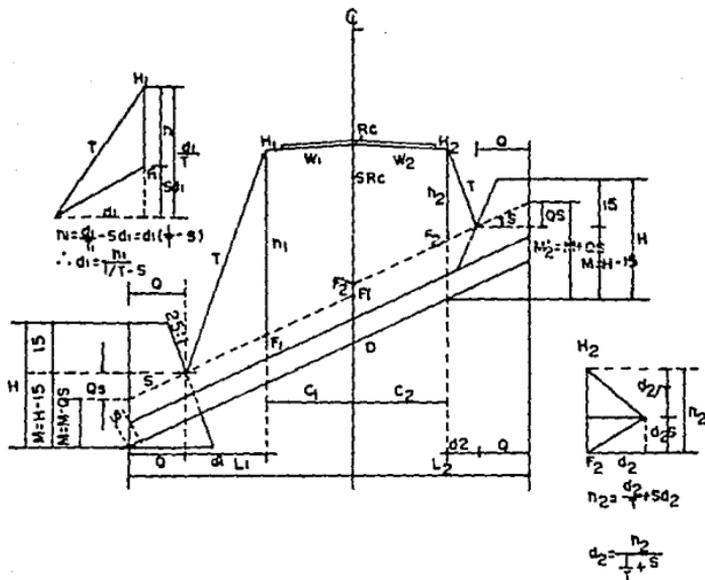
Elementos para el cálculo de longitud de las alcantarillas.
